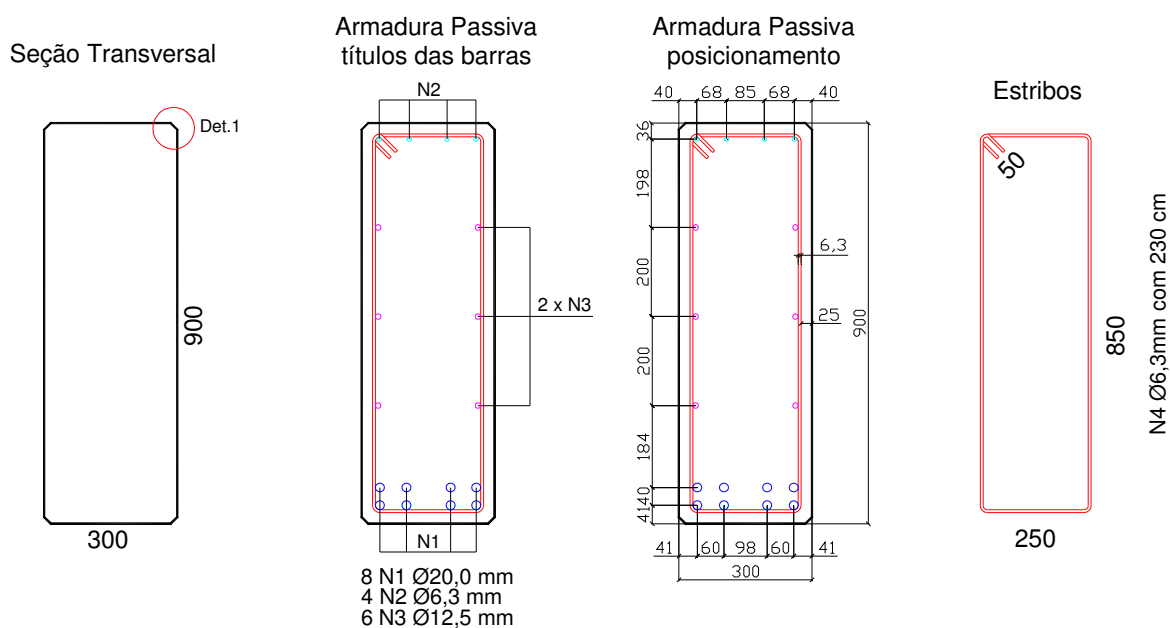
Detalhamento das armaduras passivas para concreto armado CAA II.
